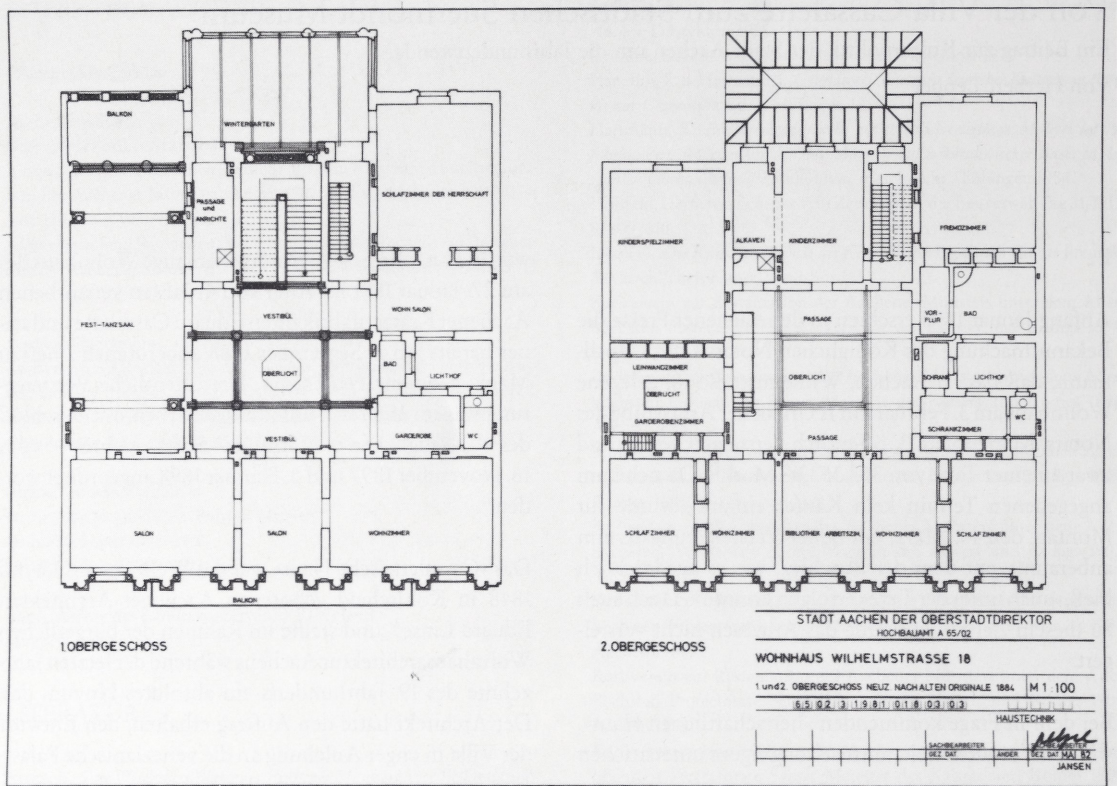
Villa Cassalette, Grundriß: I. und II. Obergeschoß
